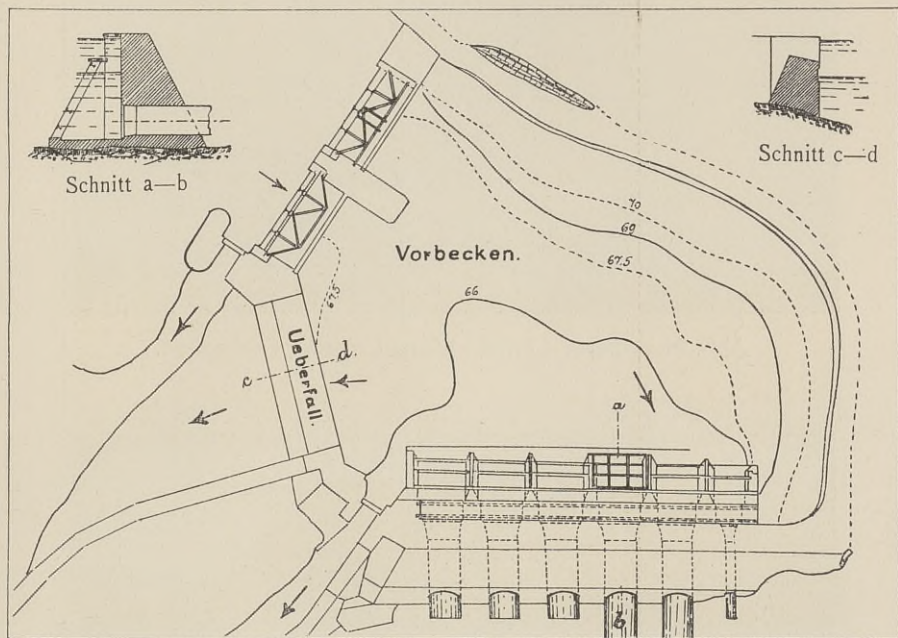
98. Oberer Lerfos. Grundriß des Vorbeckens. Maßstab 1 : 600.
